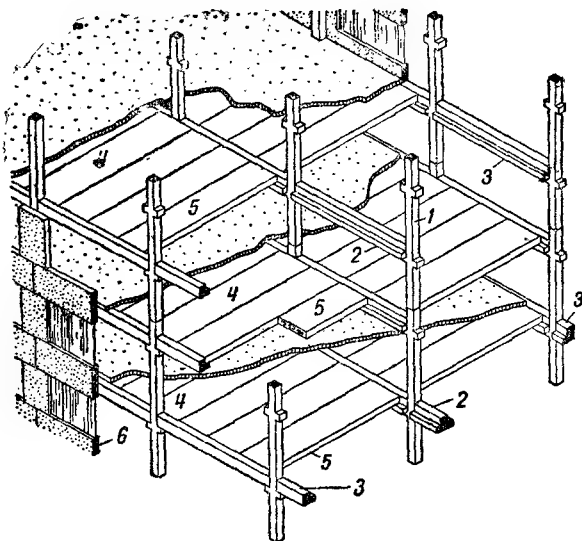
Фрагмент сборного каркасного несущего остова многоэтажного здания с продольными ригелями
